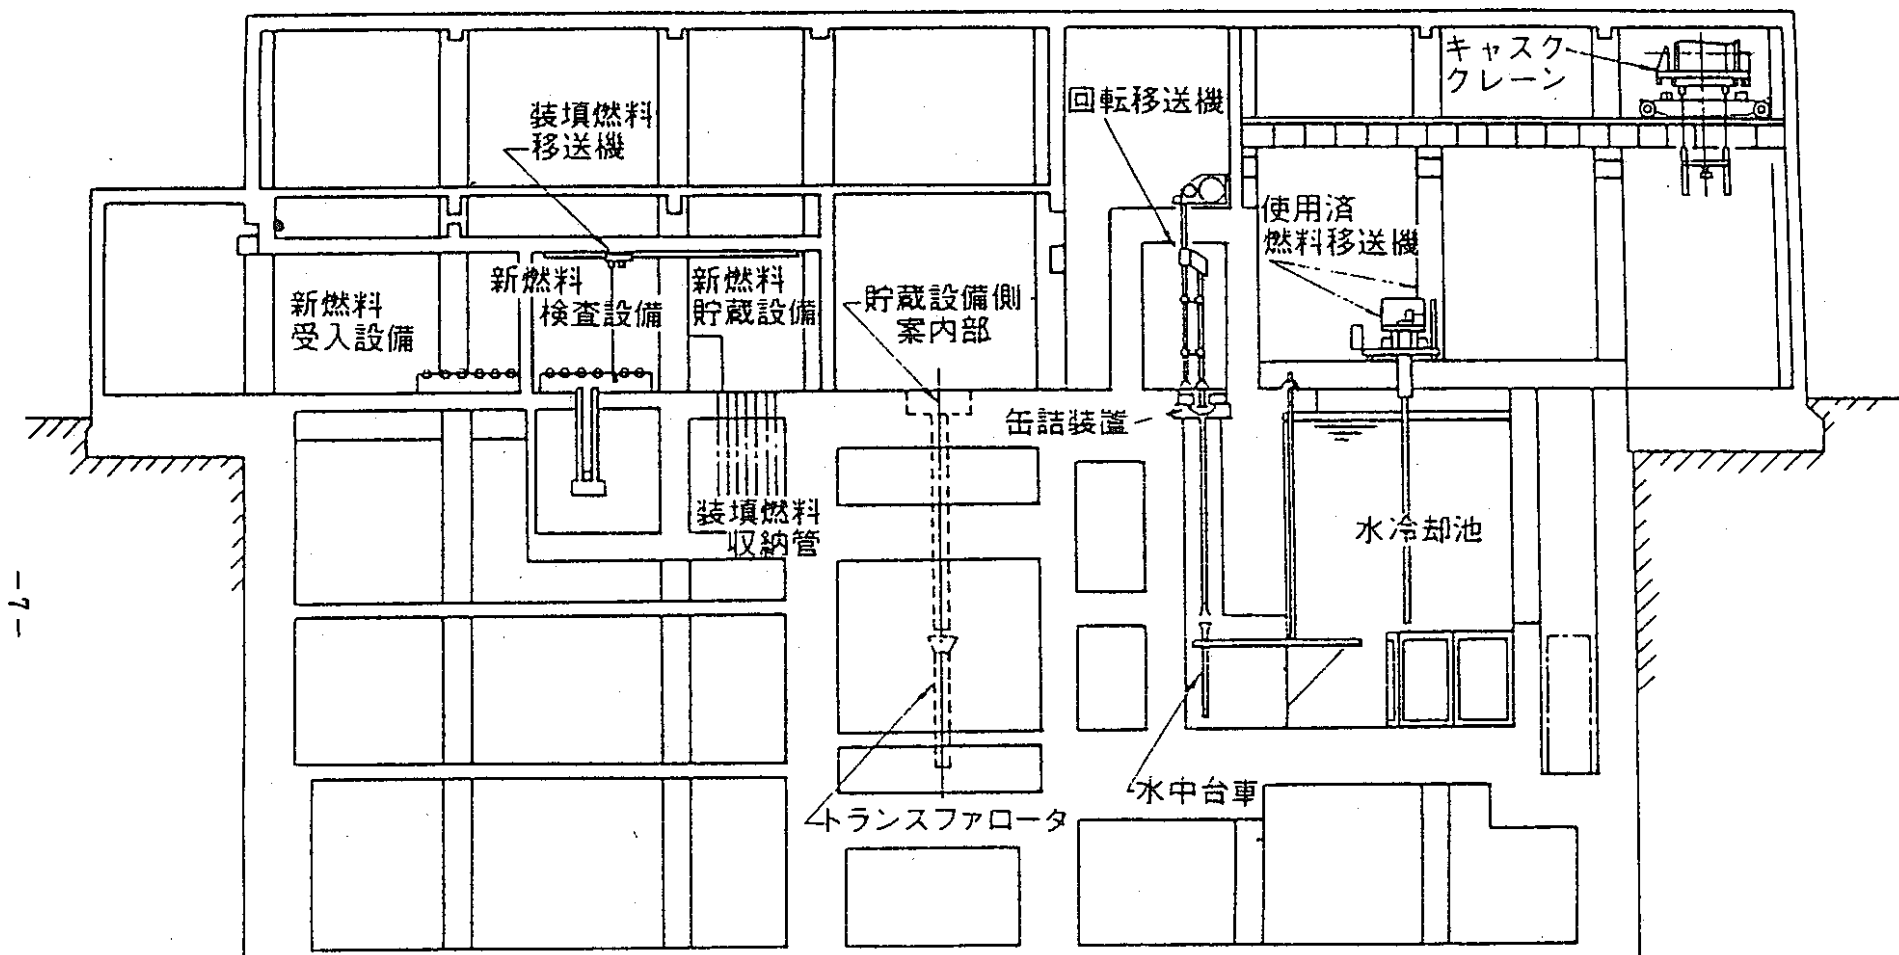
炉心構成要素の取扱及び貯蔵施設配置図 (平面図)
